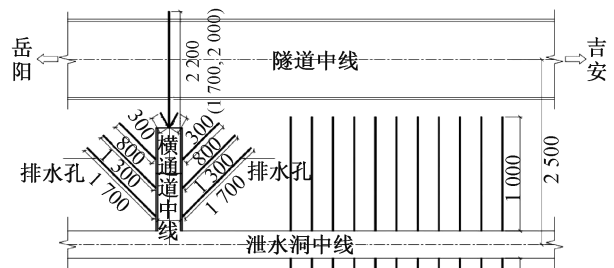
泄水洞与隧道位置关系平面图(单位:cm)
